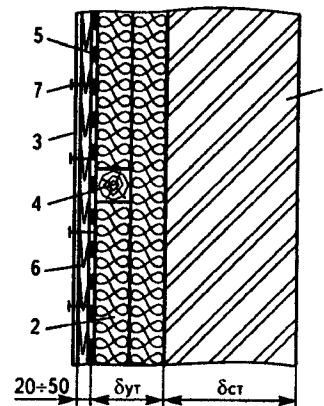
Утепление кирпичной стены плитами из стекловаты с облицовкой листовым или плитным материалом по деревянному каркасу с вентилируемым зазором:
